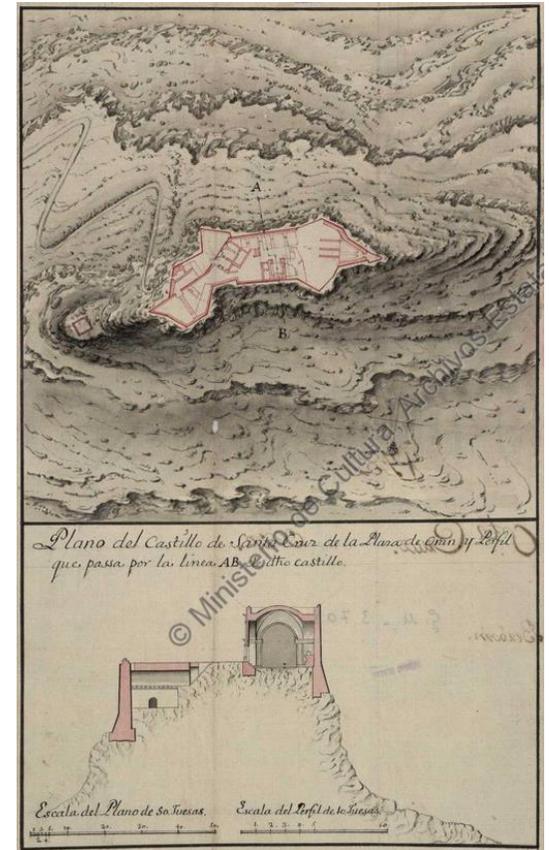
Système d'implantation de la forteresse de Santa Cruz à Oran, vu générale sur le plan. ( Archives de Simancas)
